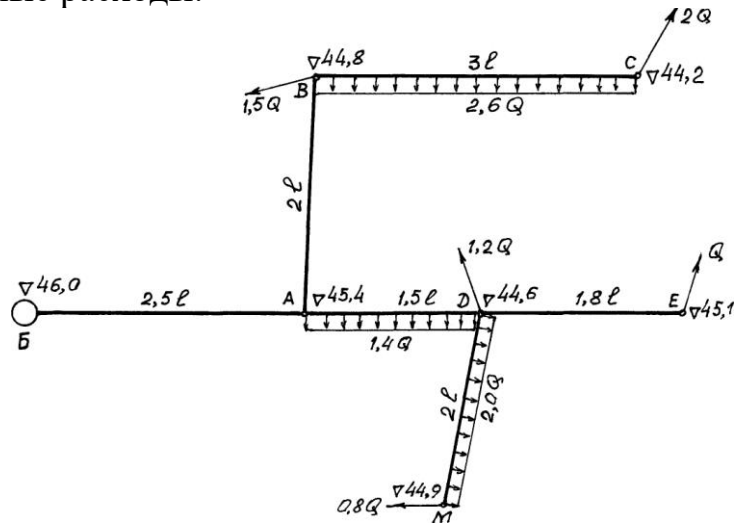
Расчетная схема разомкнутой водопроводной сети
